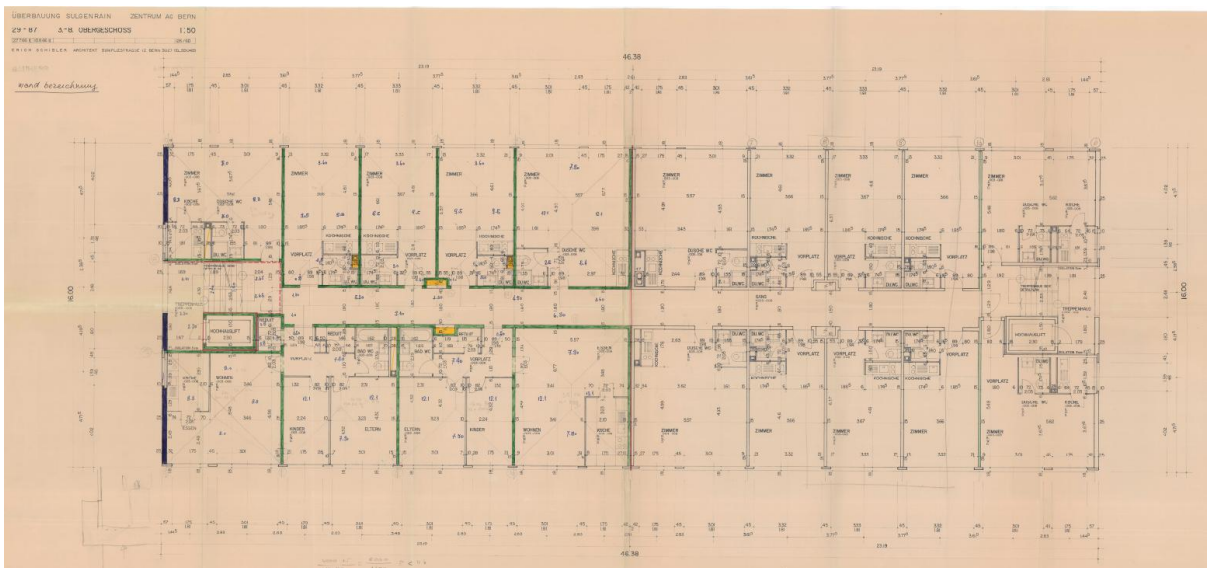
Grundriss Obergeschoss (ohne Massstab)
